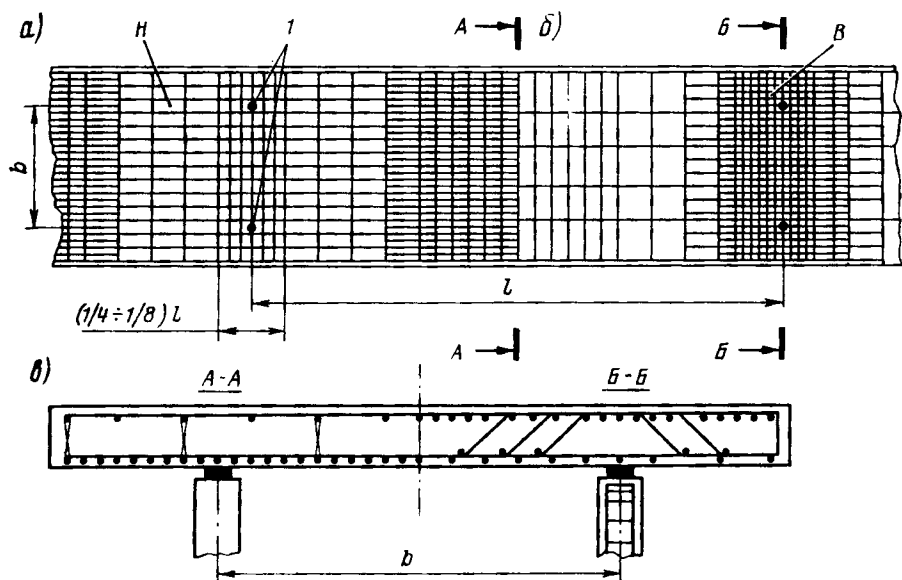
Армирование прямолинейных плитных пролетных строений ненапрягаемой арматурой:
